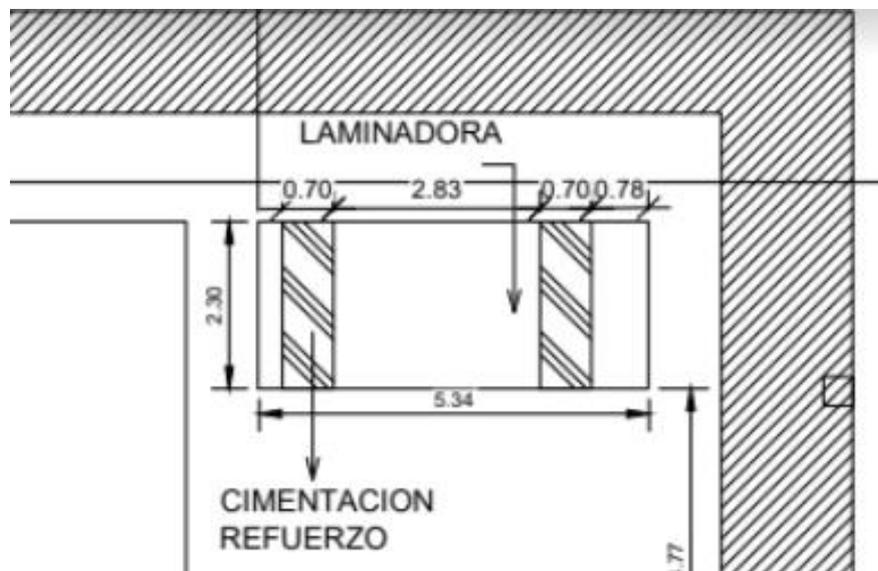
Requerimiento de refuerzo en cimentación Nave 2
